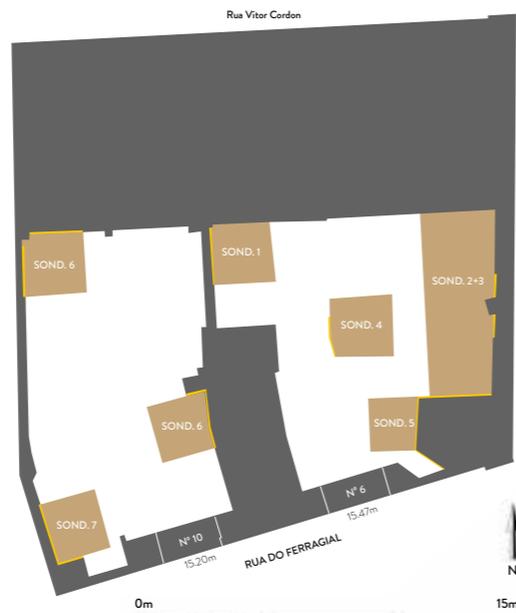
PLANO DE SONDAÇÕES EFETUADAS. ■ SONDAÇÕES PARIETAIS
